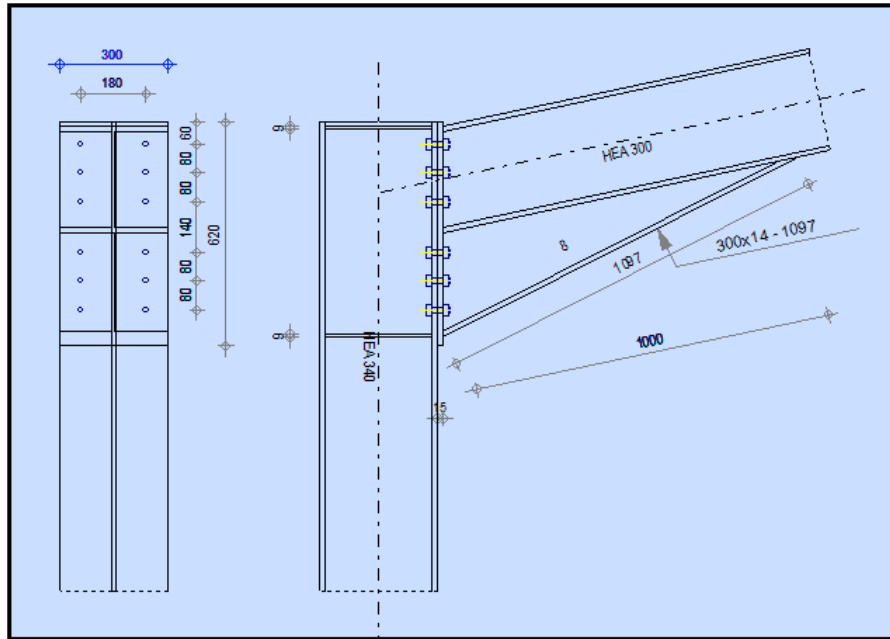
Vue en plan de l'assemblage poteau-traverse.
